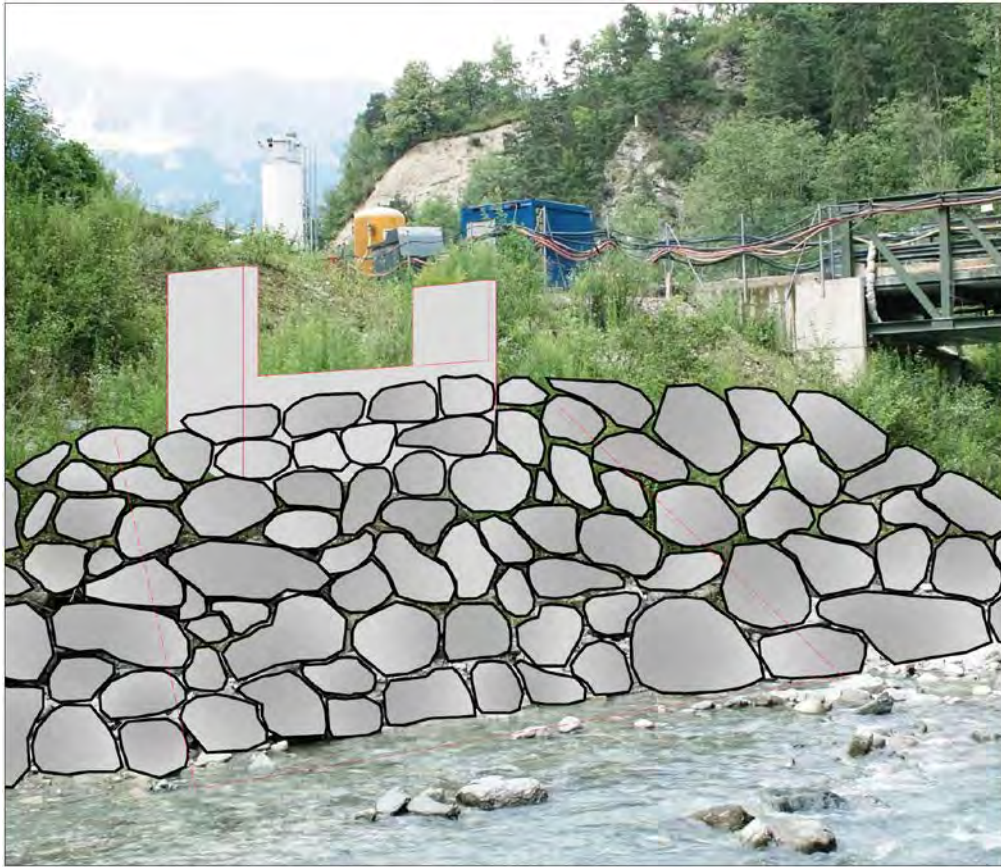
Widerlager und Deckwerk geplante Oströhre, Verlegung der Wasserbausteine in Beton nur im direkten Bereich der Brückenwiderlager
